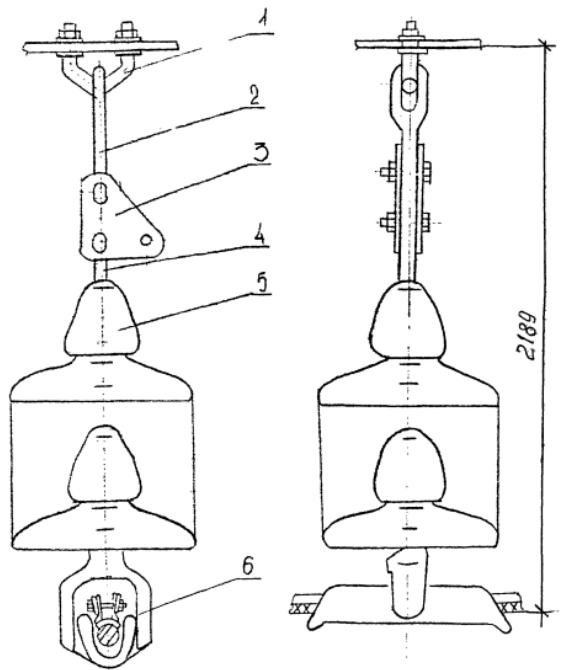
Поддерживающие изолирующие подвески троса С-70 к стальным и железобетонным опорам ВЛ220кВ
